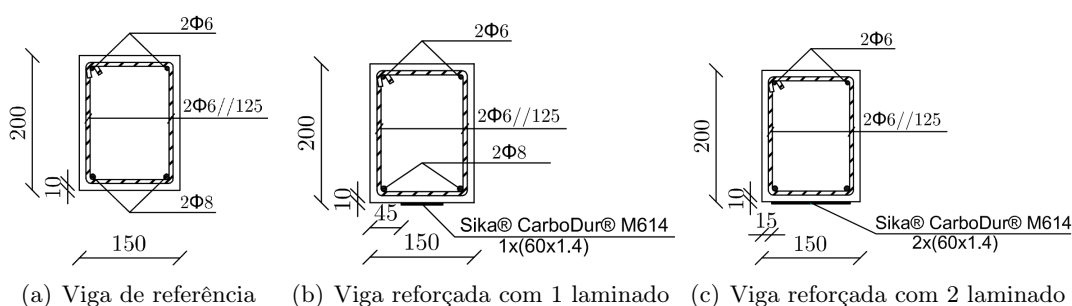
Seção transversal das vigas ensaiadas [Dimensões em mm]
